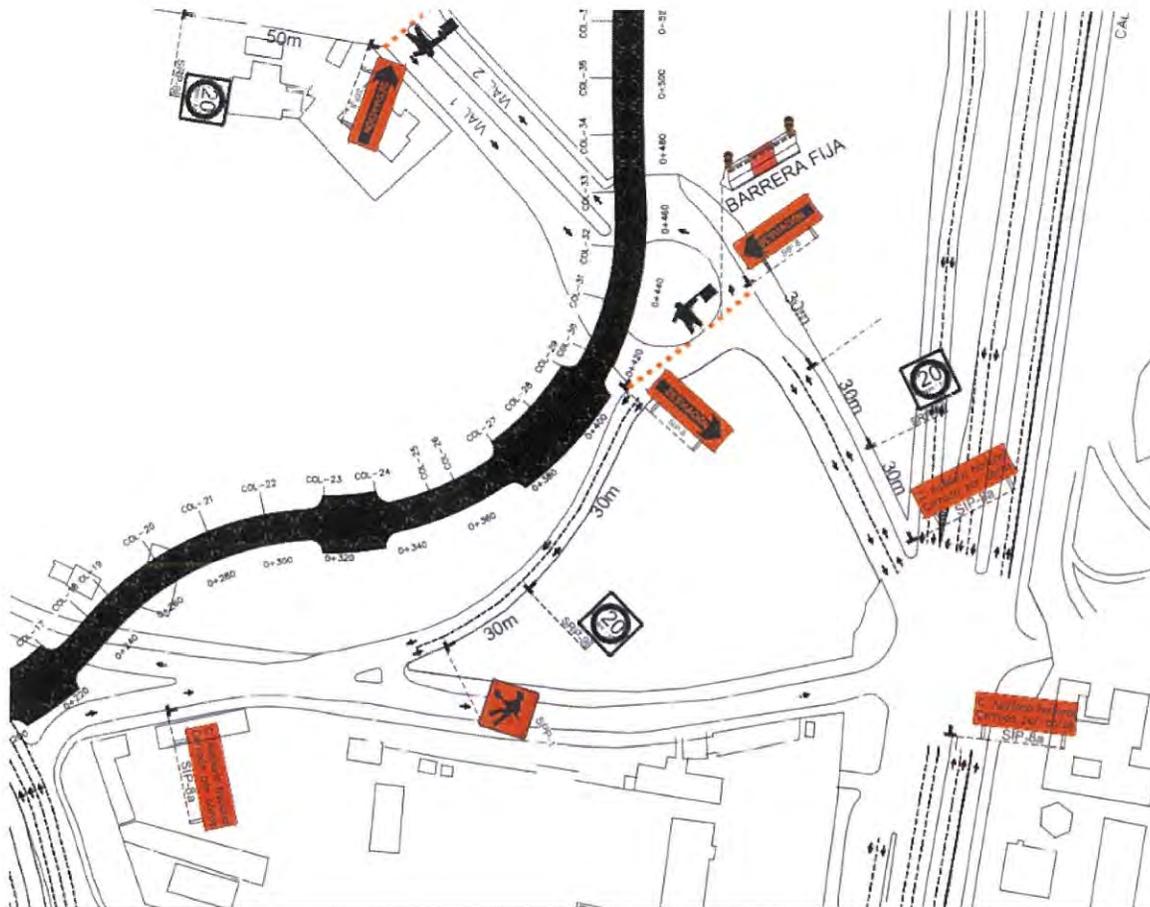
Vista en planta particular de área bloqueada por trabajos e columnas P-31, 32 y 33 en vía de la glorieta de Chivatito frente al Estacionamiento Ecológico.
